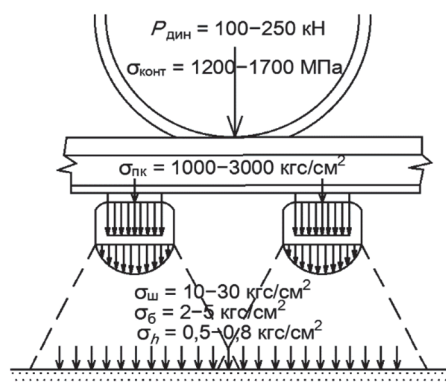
Схема передачи вертикальной нагрузки колеса на земляное полотно
